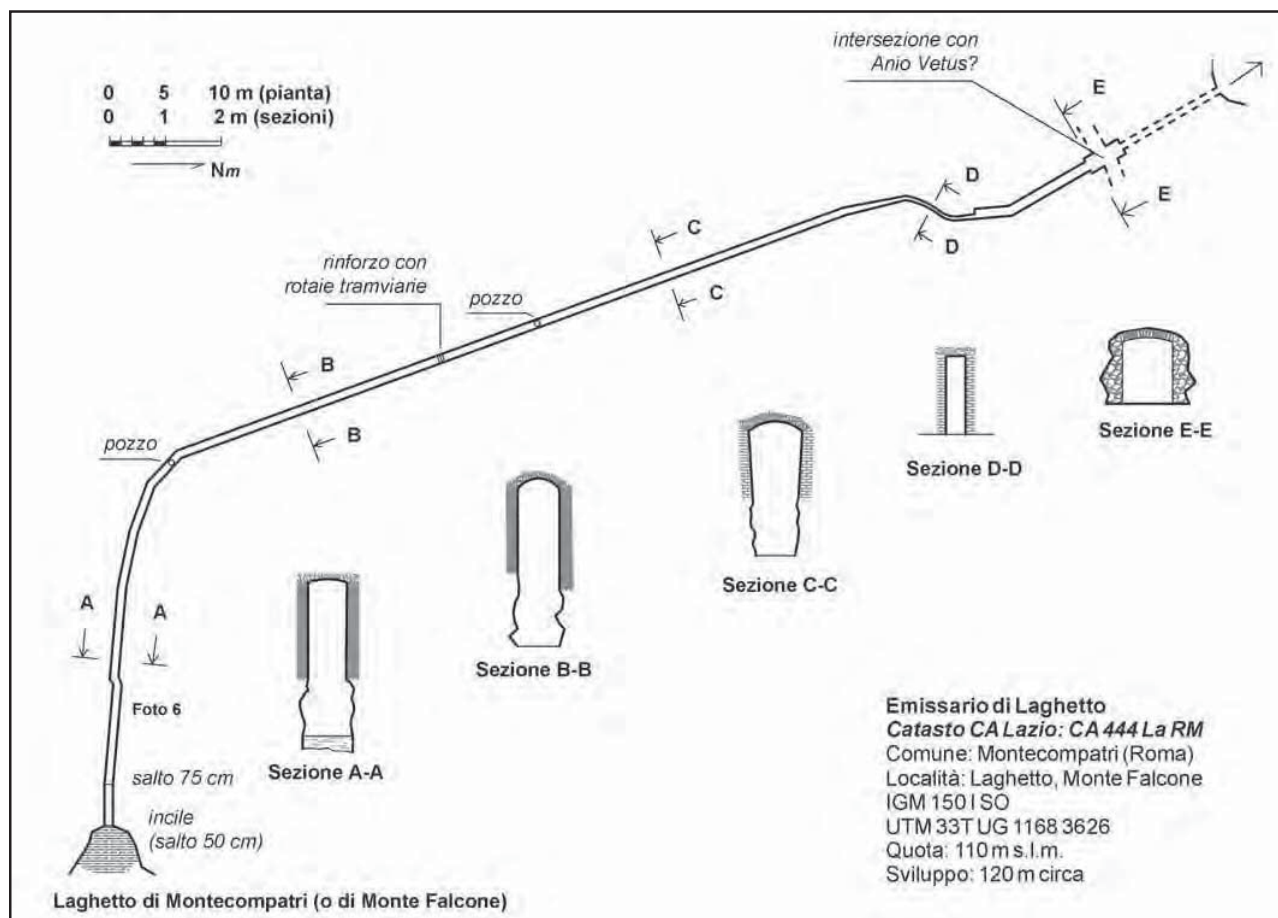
Pianta e sezioni dell'emissario di Laghetto (ril. C. Germani, T. Dobosz, V. Caloi; CRS Egeria 2010).
